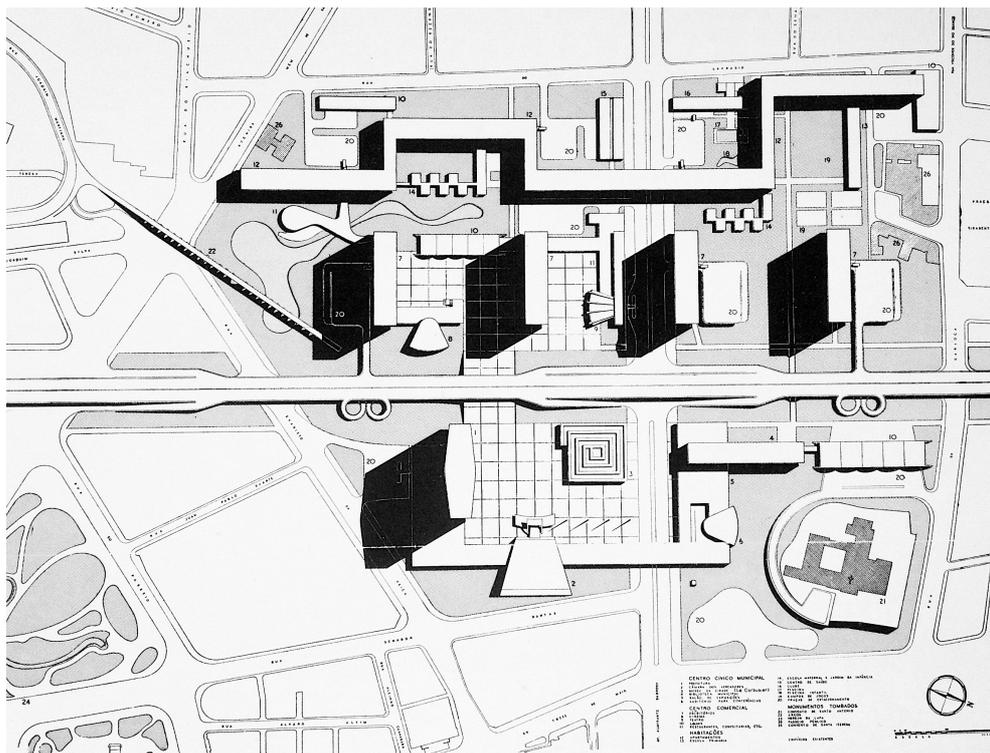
Plano de Urbanização para Esplanada de Santo Antonio. Affonso Reidy e equipe (1948).
